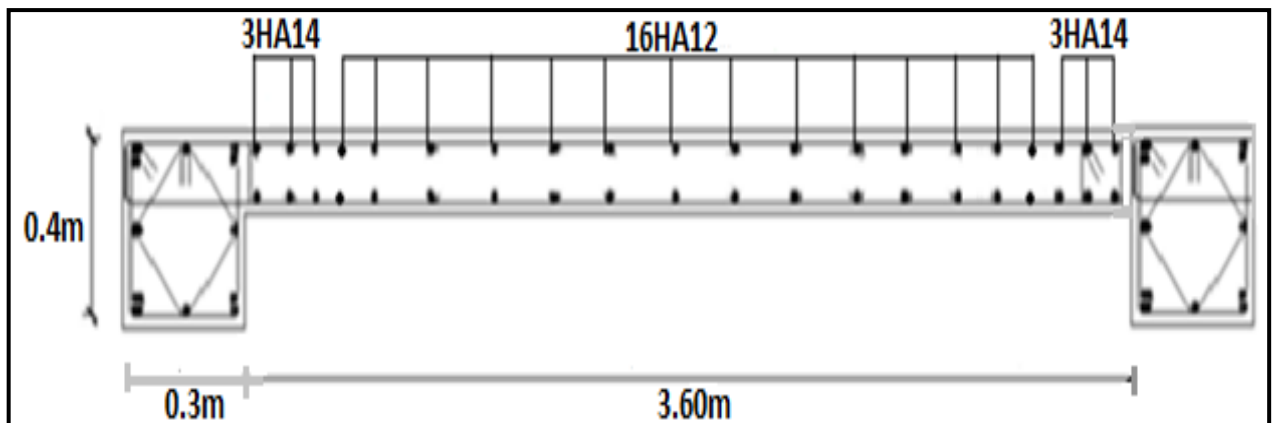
Schéma de ferrailage longitudinal de l'ensemble Poteau (RDC) et voile V4.
